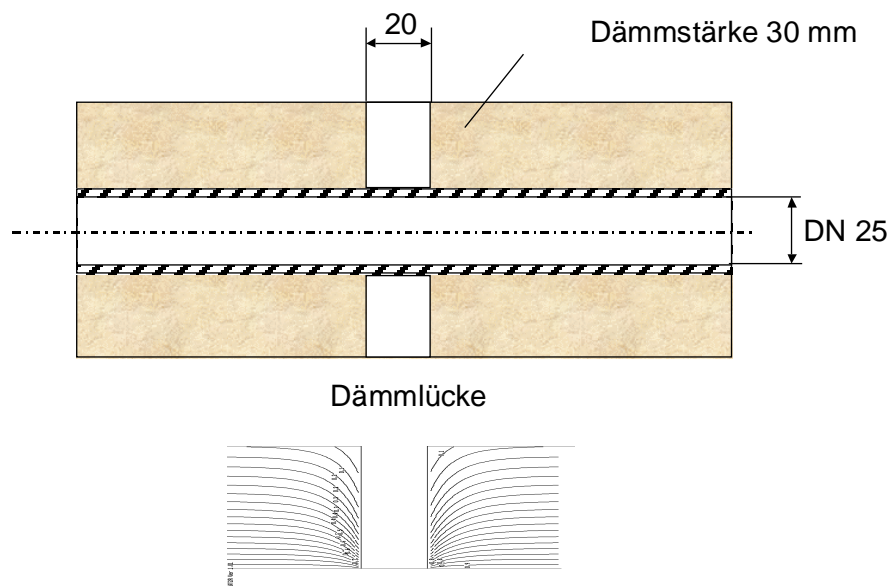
Wärmedämmte Rohrleitung (DN25) mit 30 mm Wärmedämmung und einer Dämmücke von 20 mm (Geometrie und Isothermendarstellung). Quelle: [AK 28].
